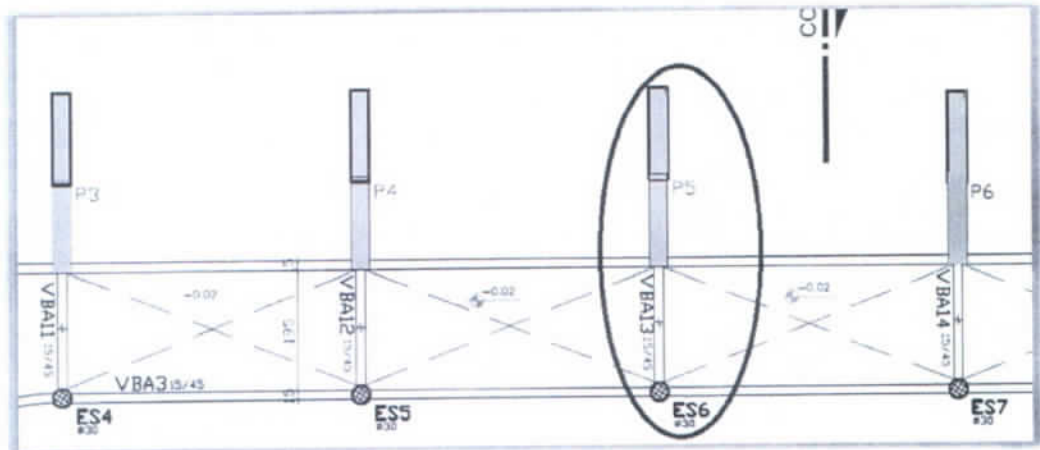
VBA 13 – PLANTA DE FORMA DO CINTAMENTO
